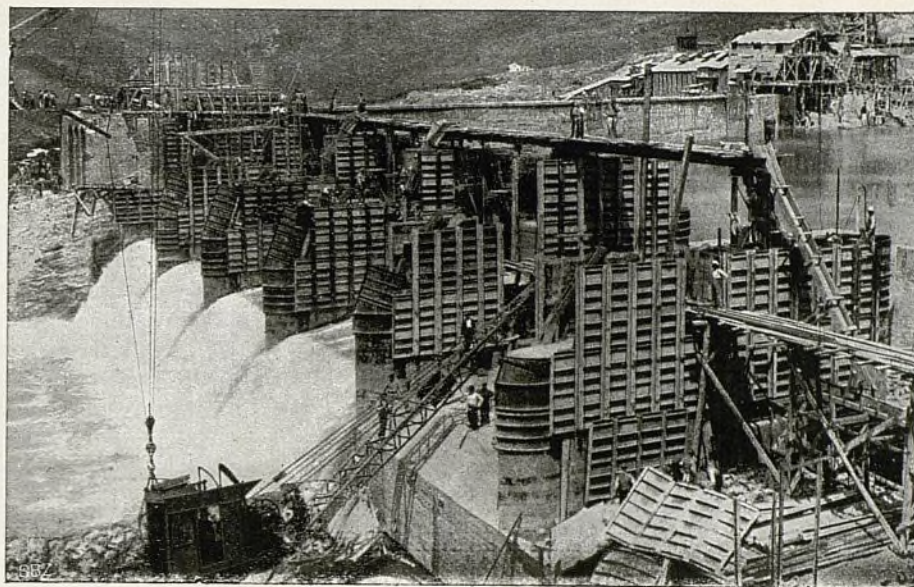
Obras de la instalación para desagüe vistas desde el SO, durante la avenida del 24 de Mayo de 1916. Los pilares de las compuertas automáticas tienen aún el maderamen de construcción.
